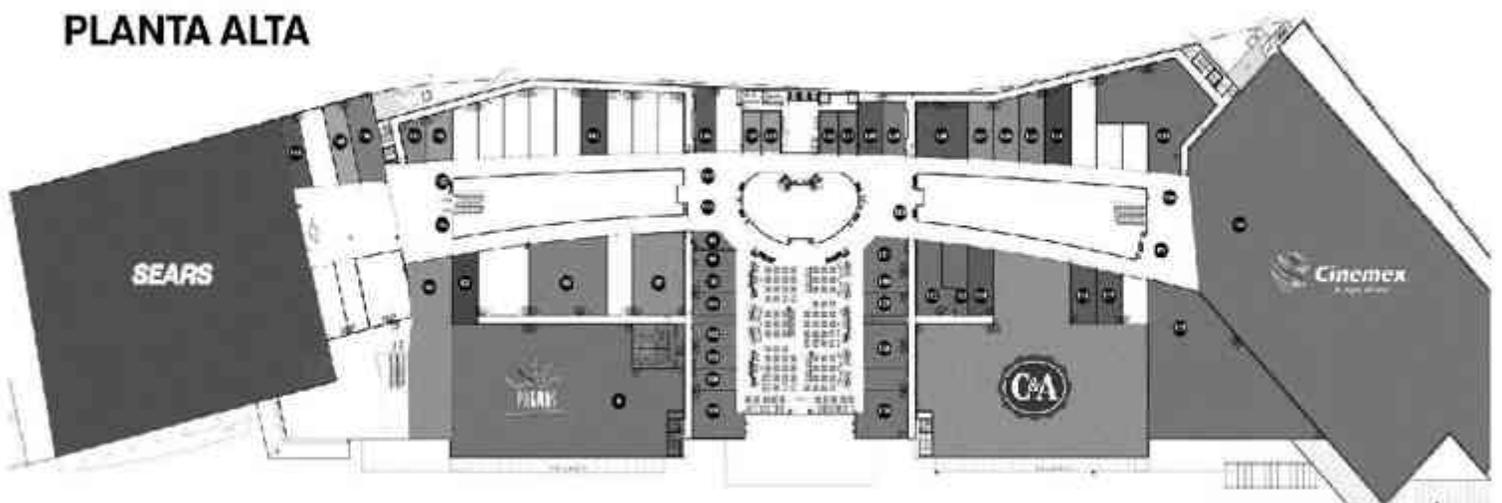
Planta alta de la Plaza Comercial San Agustín, Monterrey, Nuevo León. Foto. .
